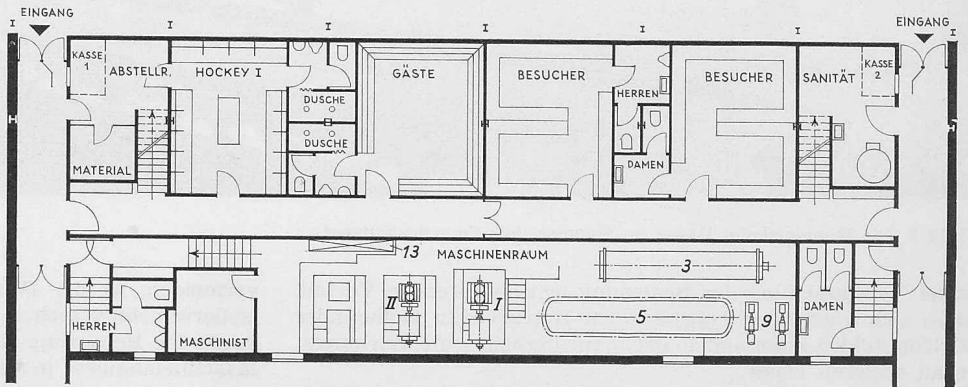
Tribünengebäude, Grundriss des Erdgeschosses, 1:300
